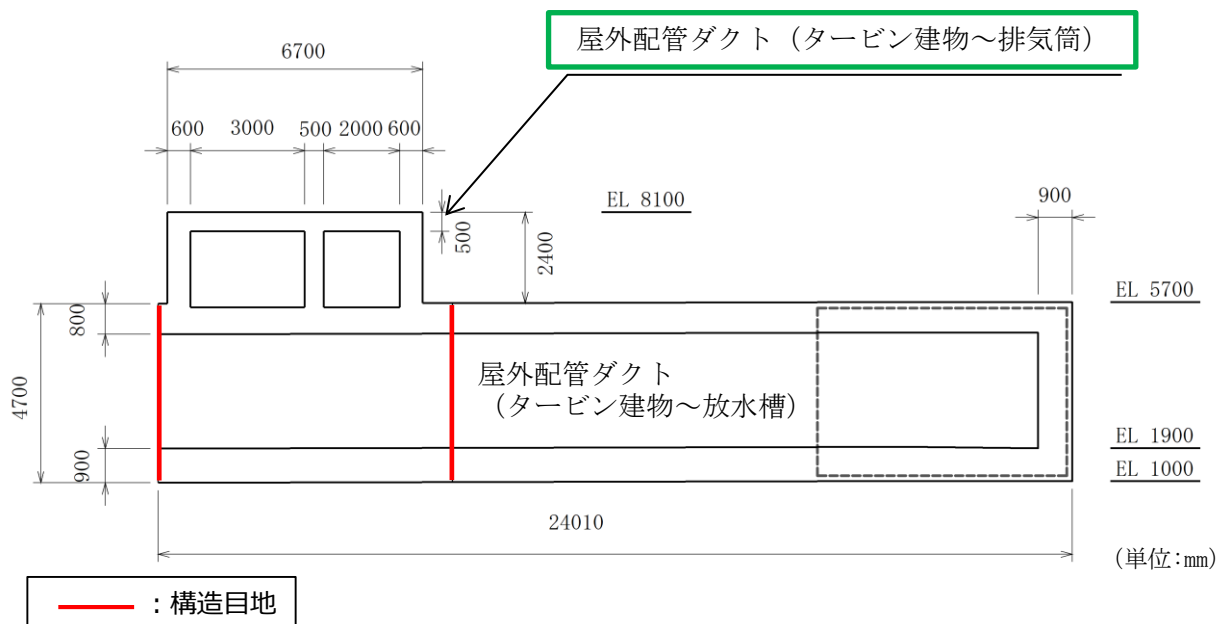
屋外配管ダクト (タービン建物～排気筒) 断面図 (B-B断面)
